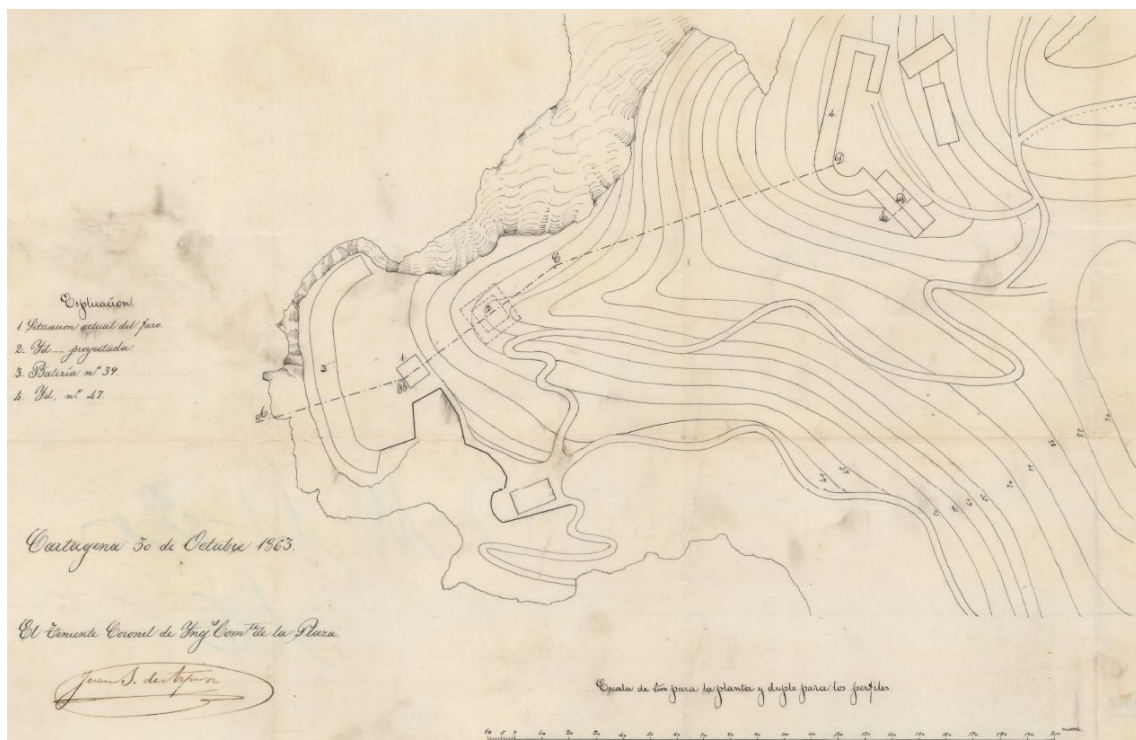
Plano de la situación proyectada del faro de la Podadera. Fuente: Plano y perfil del terreno comprendido entre la batería n° 39 y la 47 para indicar la situación proyectada del faro de la Podadera. Juan B. Aziproz, 1863 (AGMM: MU-2/16-BVD)
